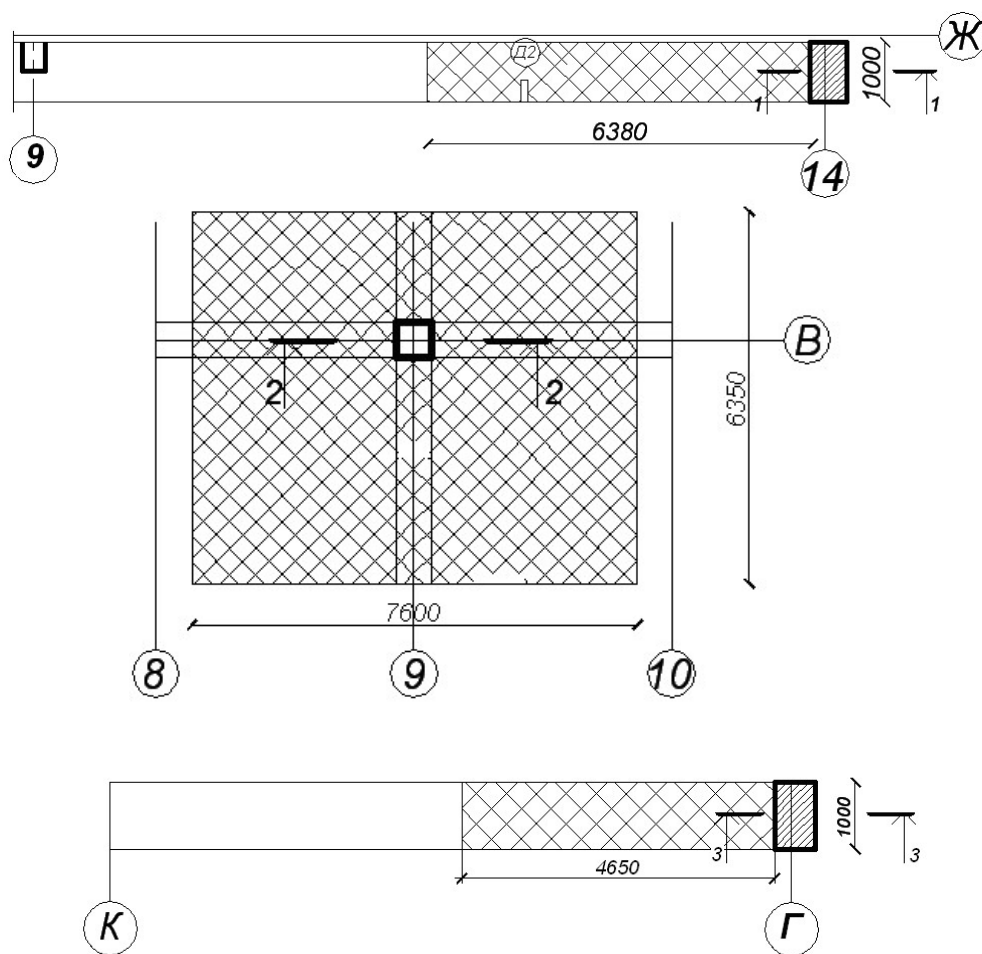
Площа розподілу навантажень на фундамент
